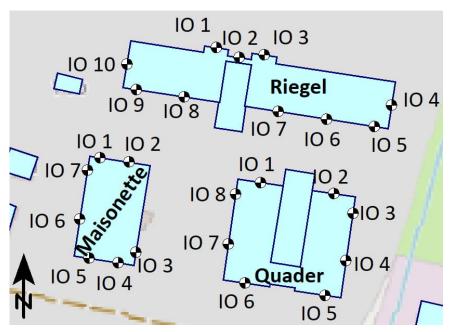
Auszug Lageplan mit Immissionsorten (IO)
